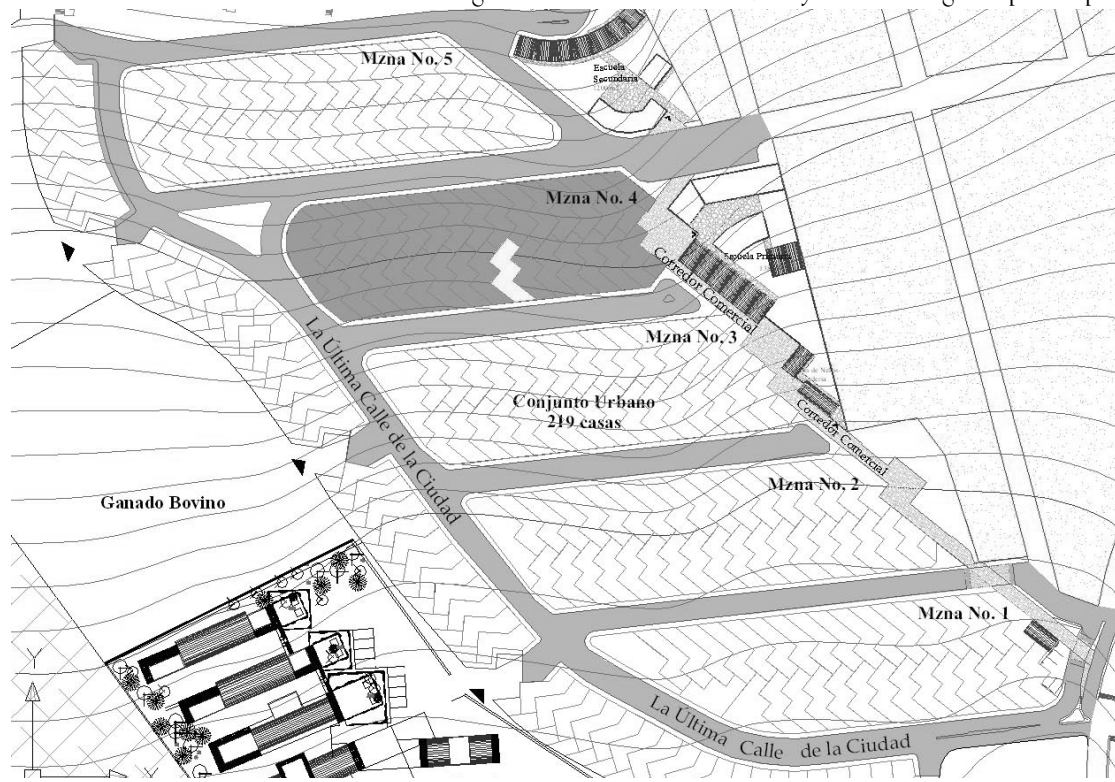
Distribución de Manzanas y terreno designado para el proyecto arquitectónico
